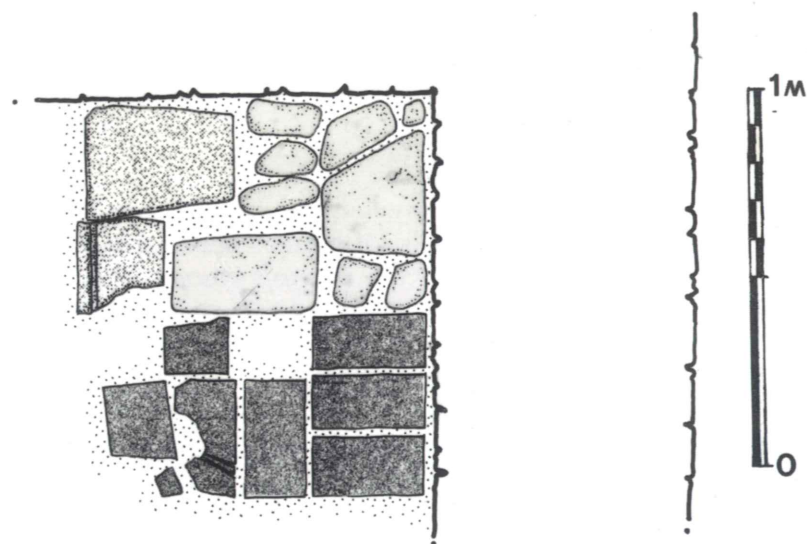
Pavimentazione dell'edificio nord-ovest. Si evidenzia l'uso di mattoni e lastre di pietra calcarea oltre all'inserimento di elementi architettonici di recupero (dis. M. Avanzini).
